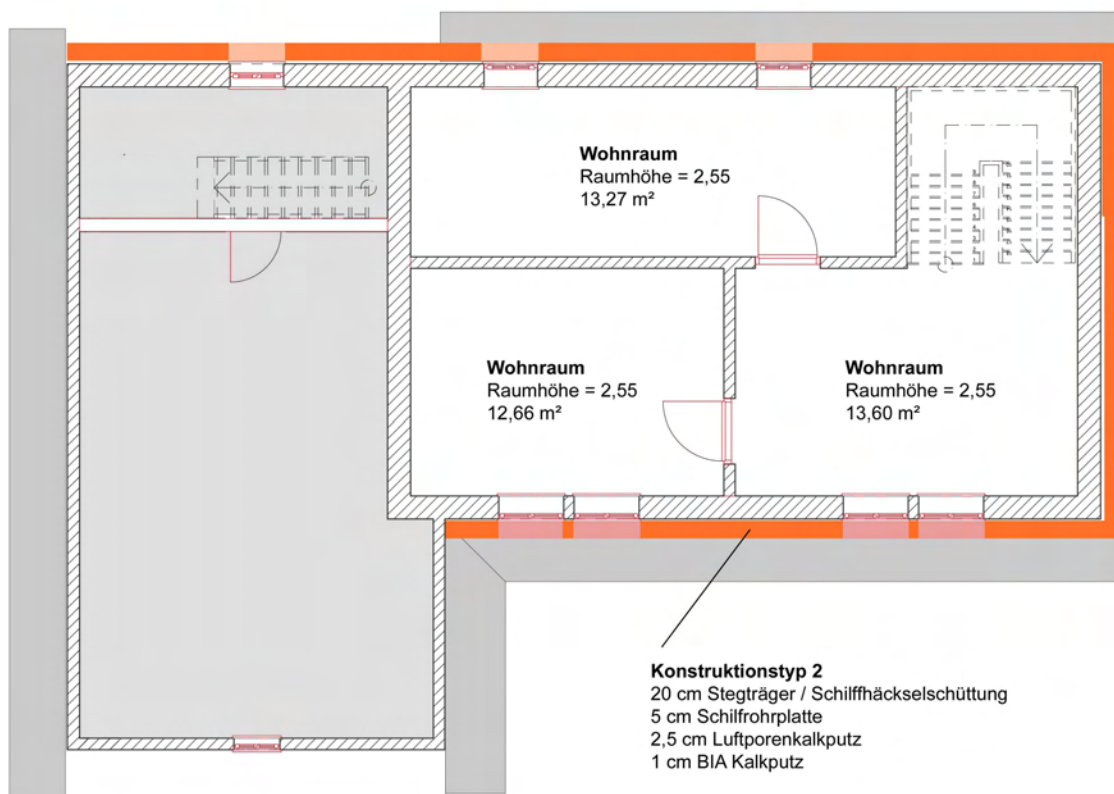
Grundrisschema OG für Sanierungsvariante „Außendämmung“
